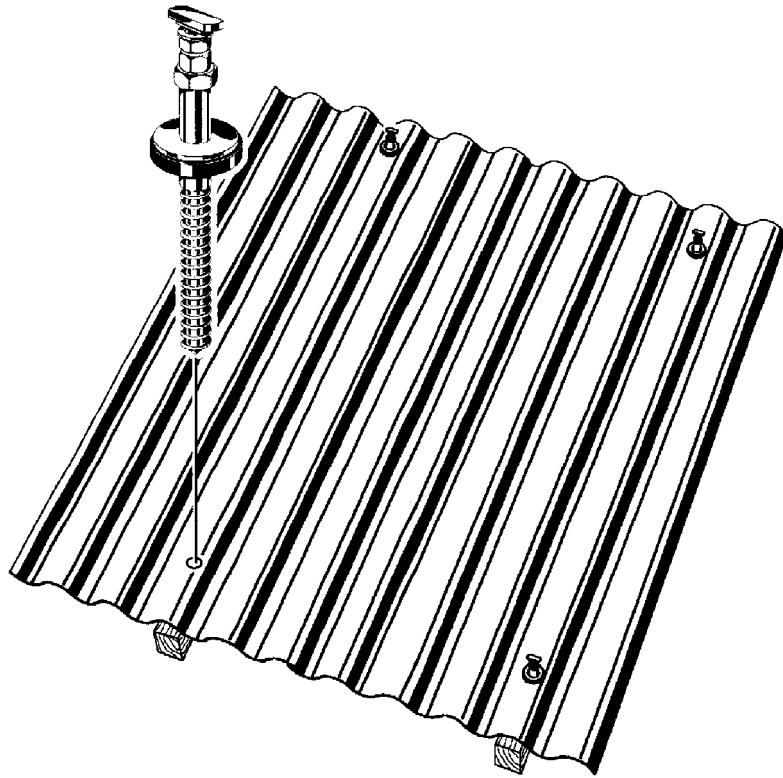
Schéma d'ensemble du montage en appui sur toiture ondulée
